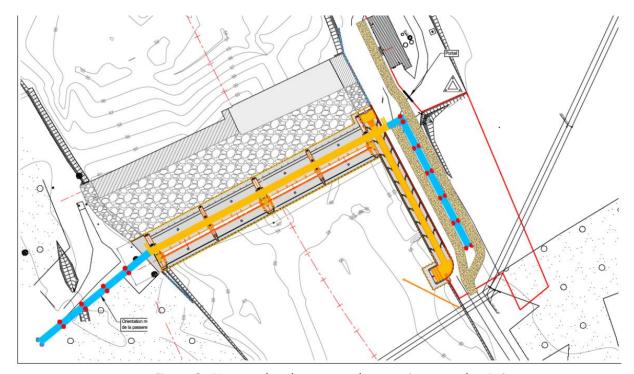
Vue en plan du nouveau barrage (source : dossier)
